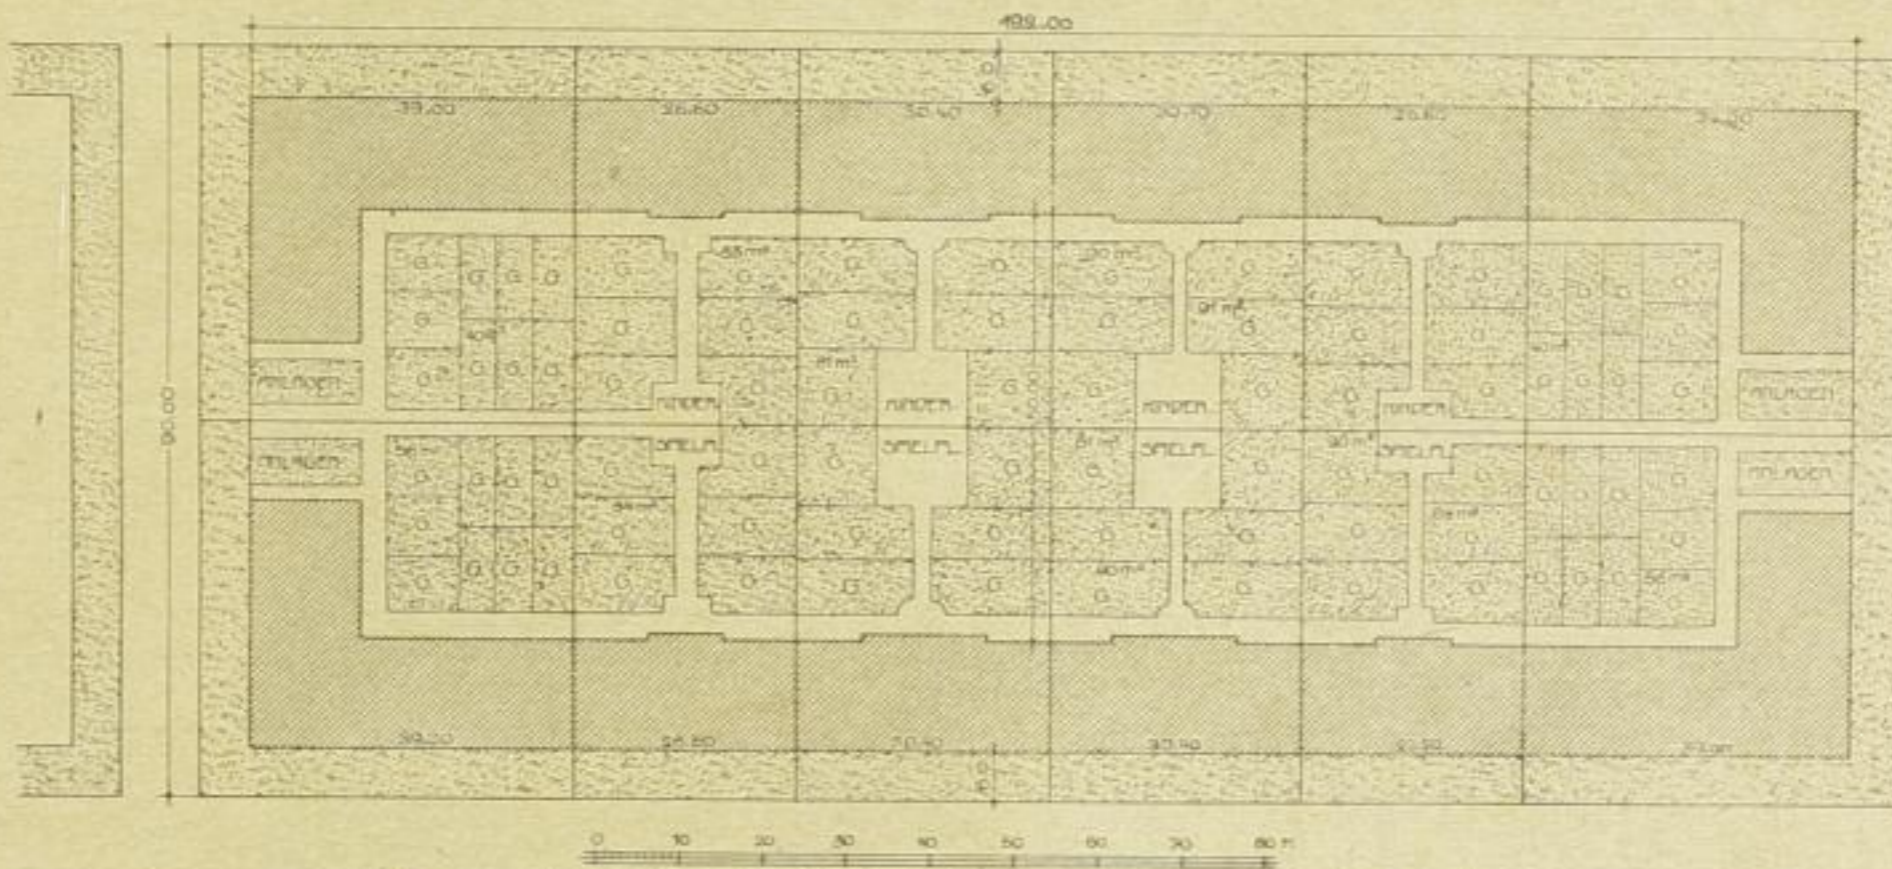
Typ eines Baublocks mit 3 geschossiger Mietshausbebauung.
